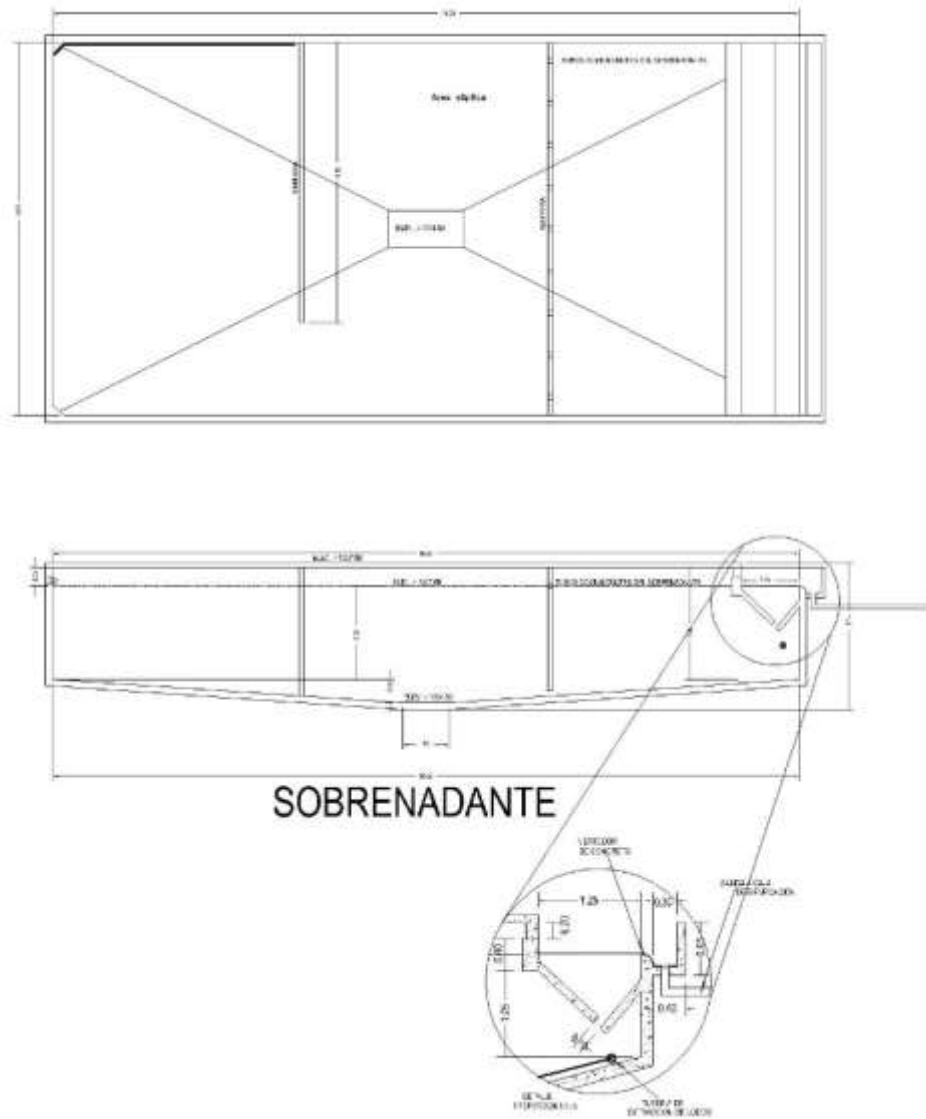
Plano de detalle del tanque séptico (Fuente: *planos originales del proyecto*).
